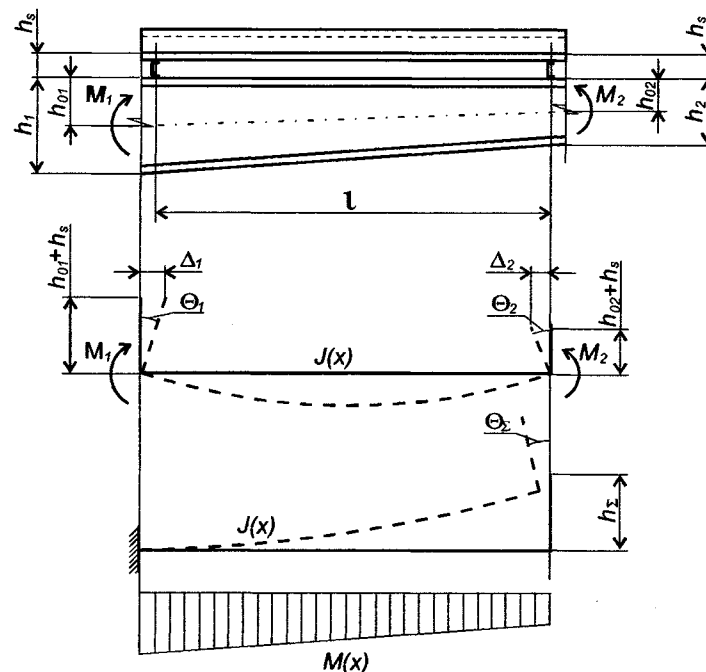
Расчетная схема для определения продольных усилий в профлисте при деформировании элемента рамы
